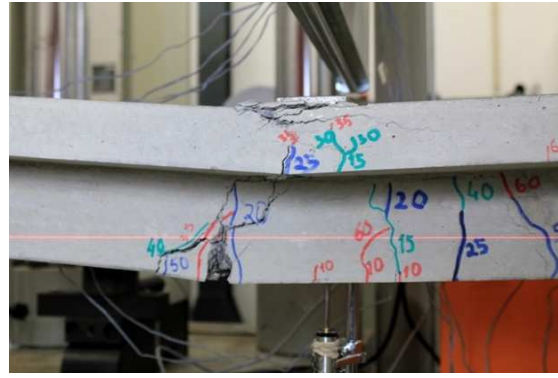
Estado do vão direito na rotura da viga G1-b
